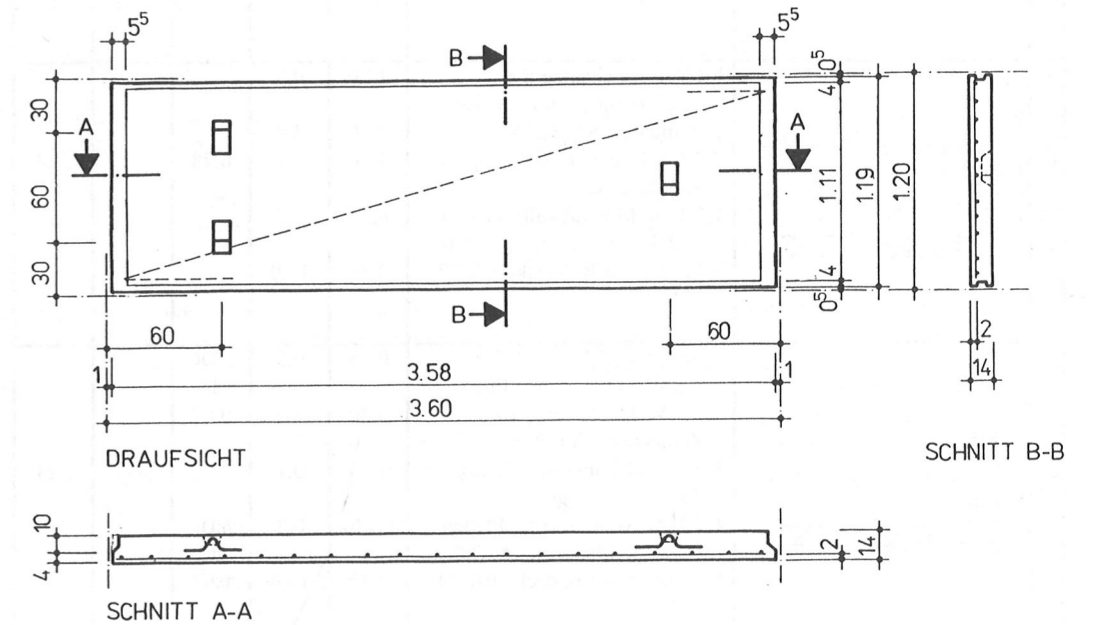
Deckennormalelement Variante Vollbeton
